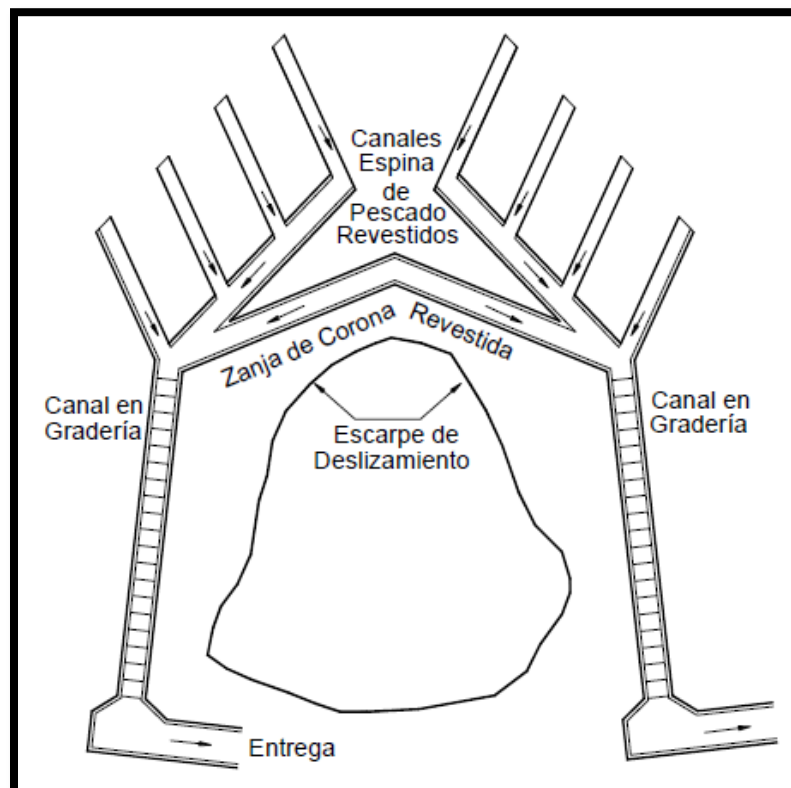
Esquema en planta de canales colectores Espina de Pescado.
